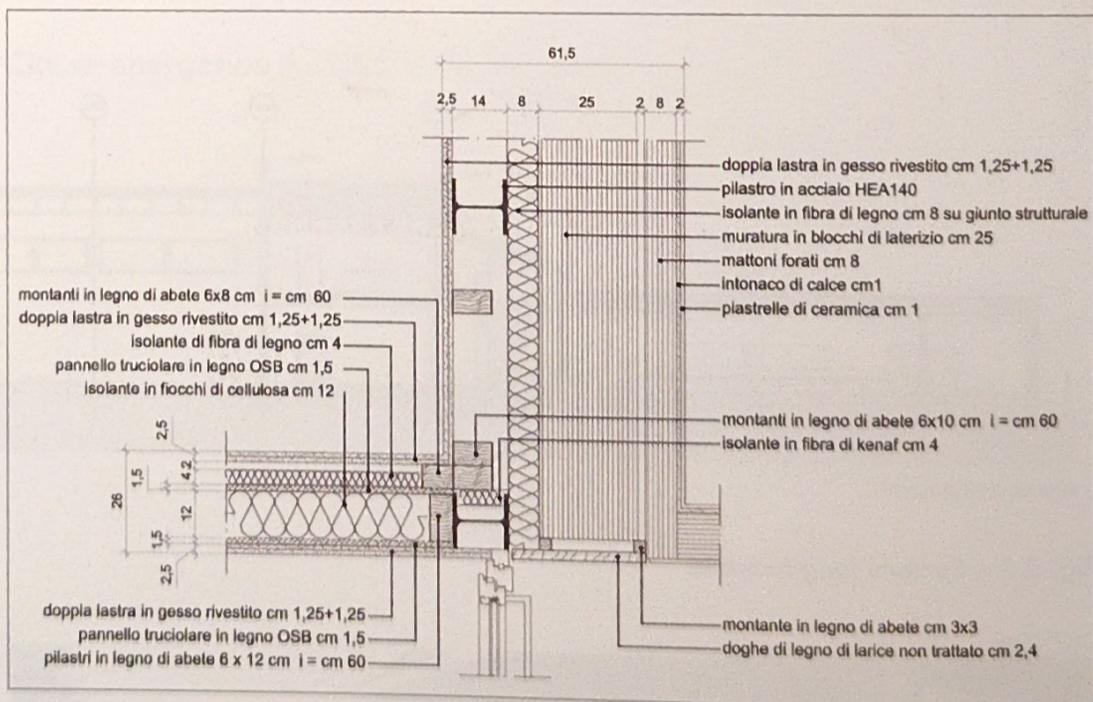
Particolare costruttivo in sezione orizzontale.
